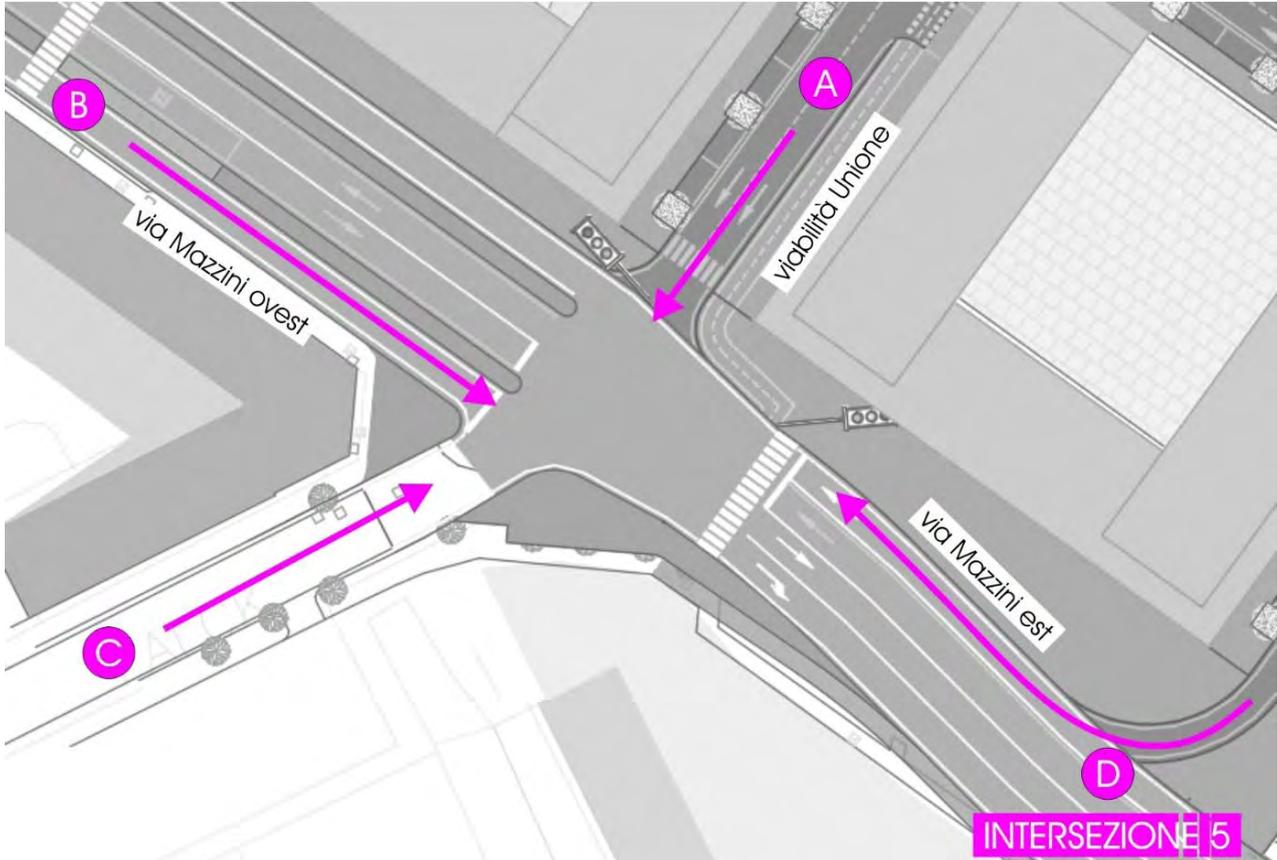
Scenario di Intervento 2 – Planimetria intersezione 5
